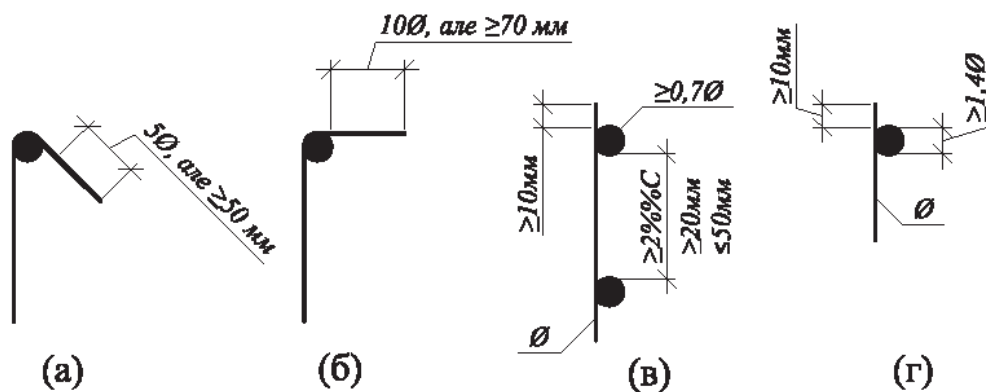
Анкерування поперечною арматурою окремих стержнів:
